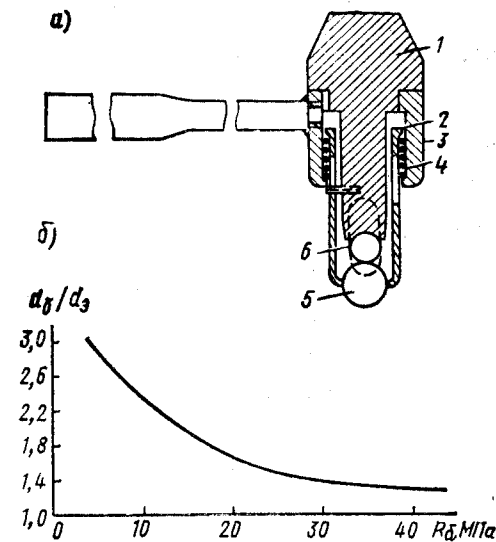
Испытание эталонным молотом Кашкарова:
